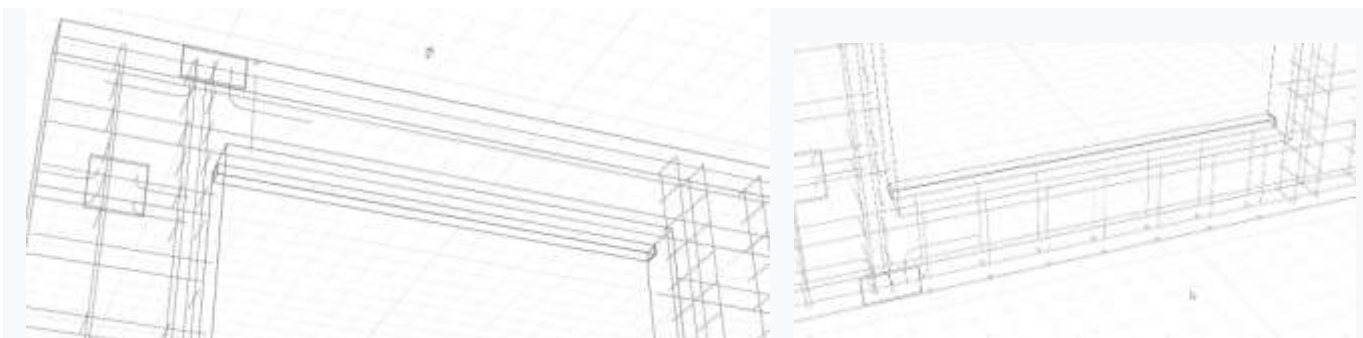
Ручное армирование зоны под проемом. Копирование стержней
